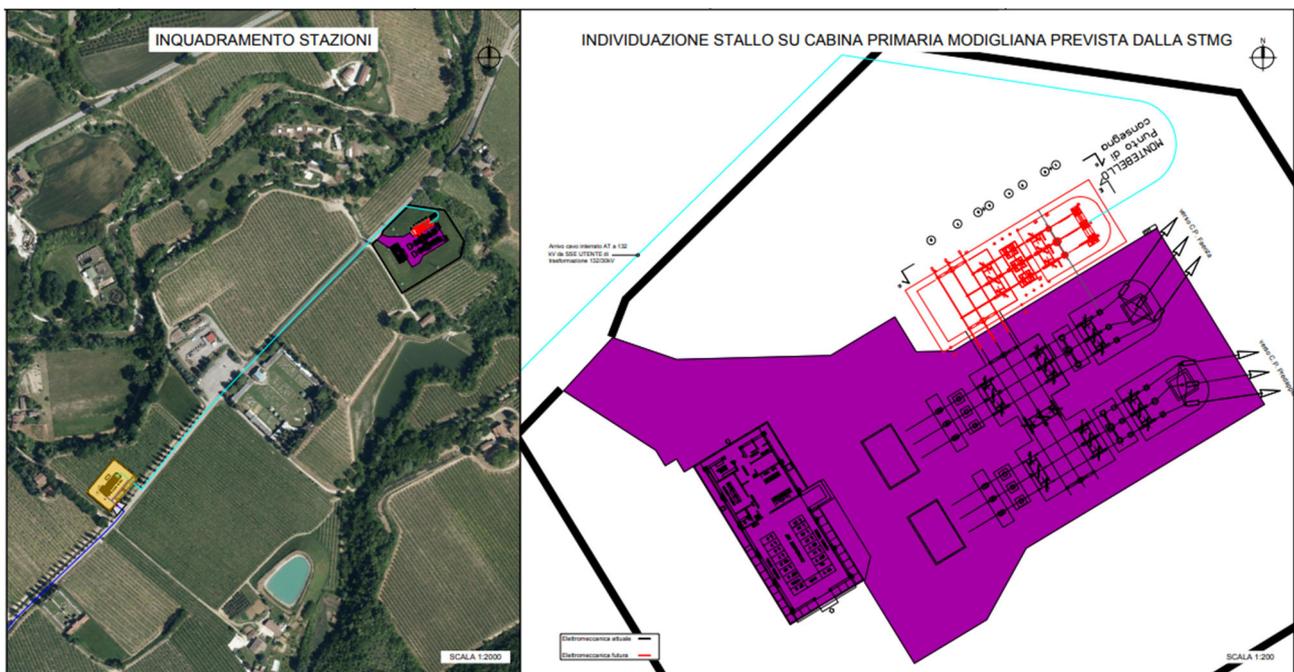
Layout delle opere di rete per la connessione alla C.P. Modigliana; in rosso l'infrastruttura esistente
